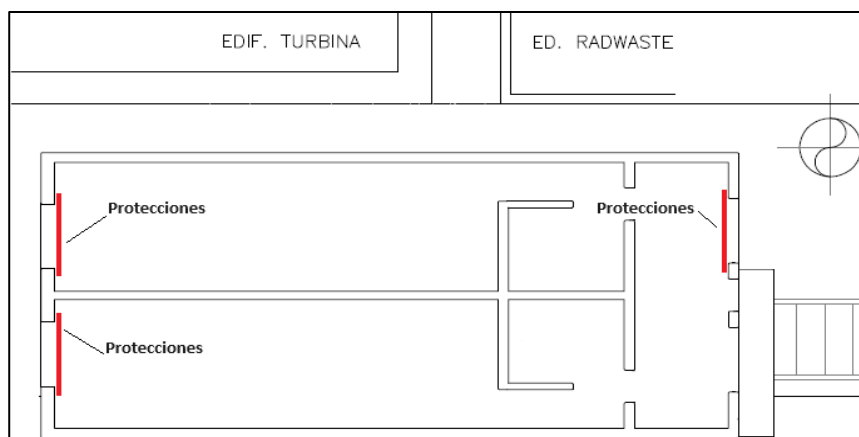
Entreplanta del Edificio SBGT, disposición de protecciones
